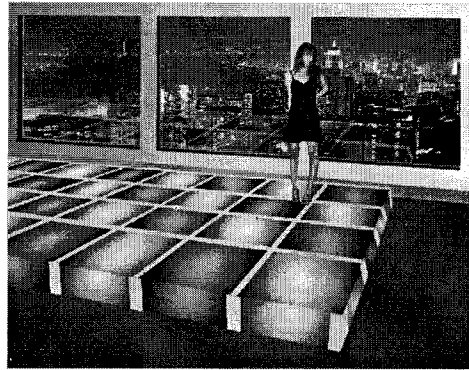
Penutup lantai *raised floor* yang dirasa kurang estetik seperti dari material MDF perlu mendapat penyelesaian tambahan, seperti karpet. Hal ini akan sekaligus menambah kemampuan redaman lantai.
